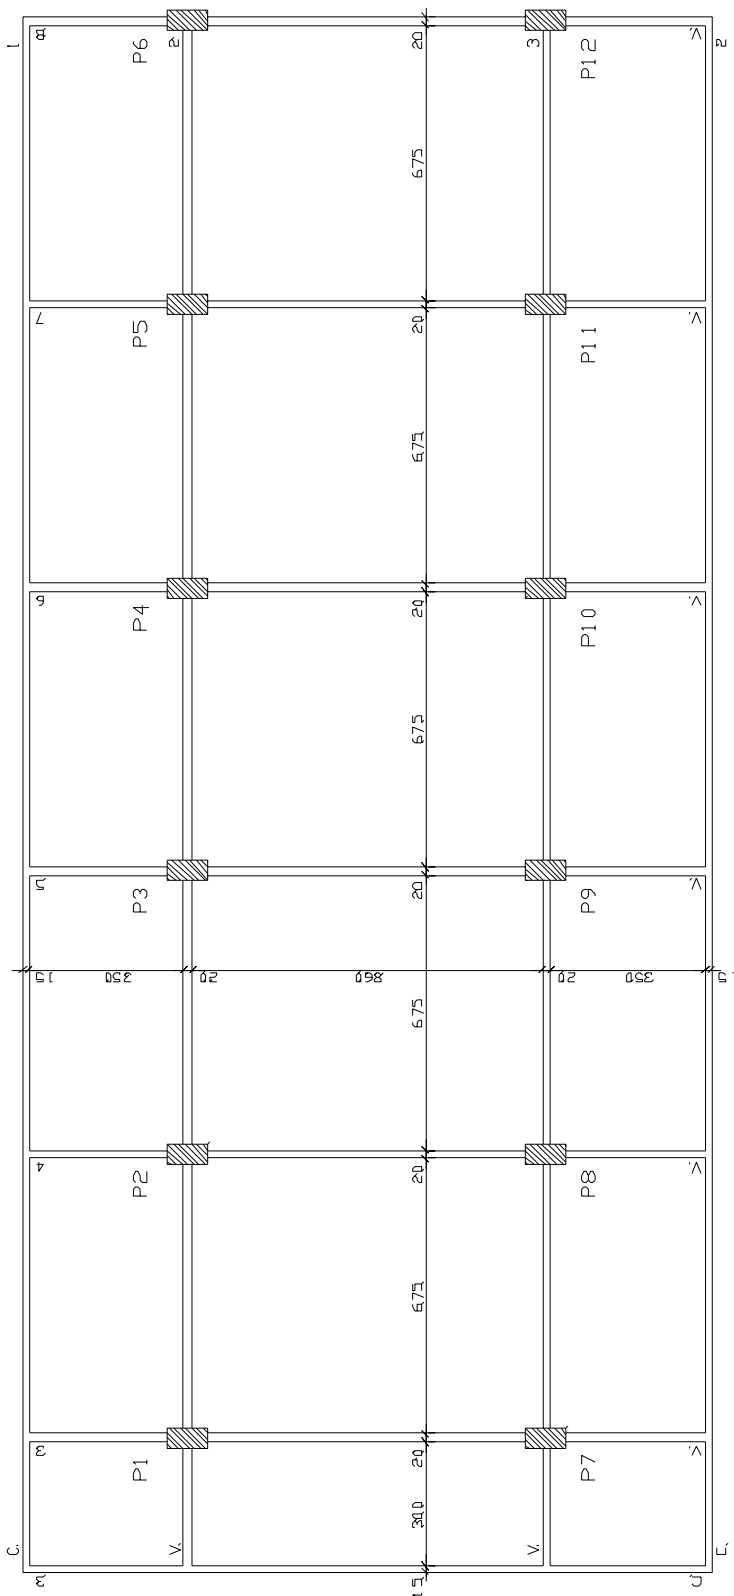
Esquema estrutural em planta do nível térreo do Condomínio Edifício Flávia.
